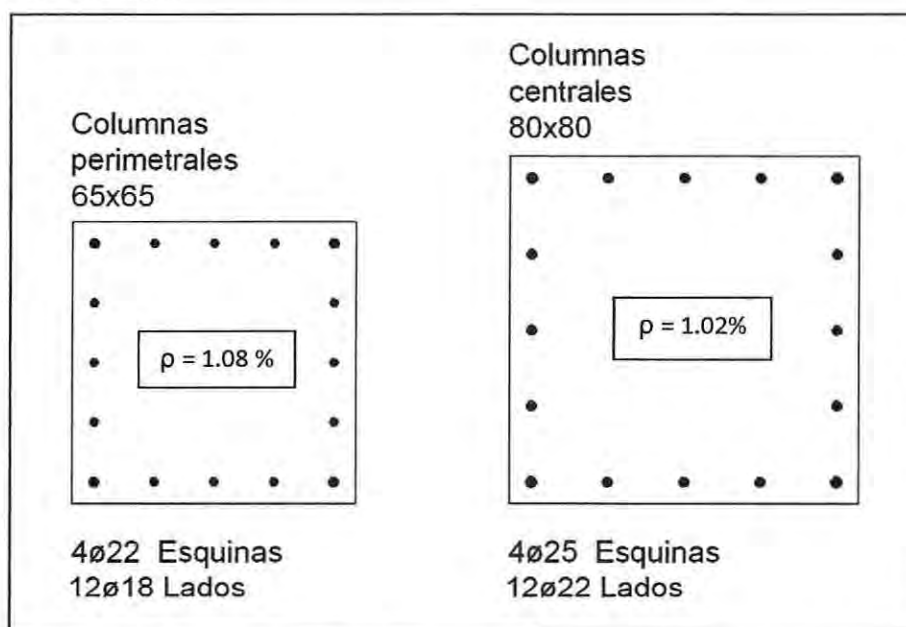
Distribución de la armadura longitudinal en columnas tipo.
